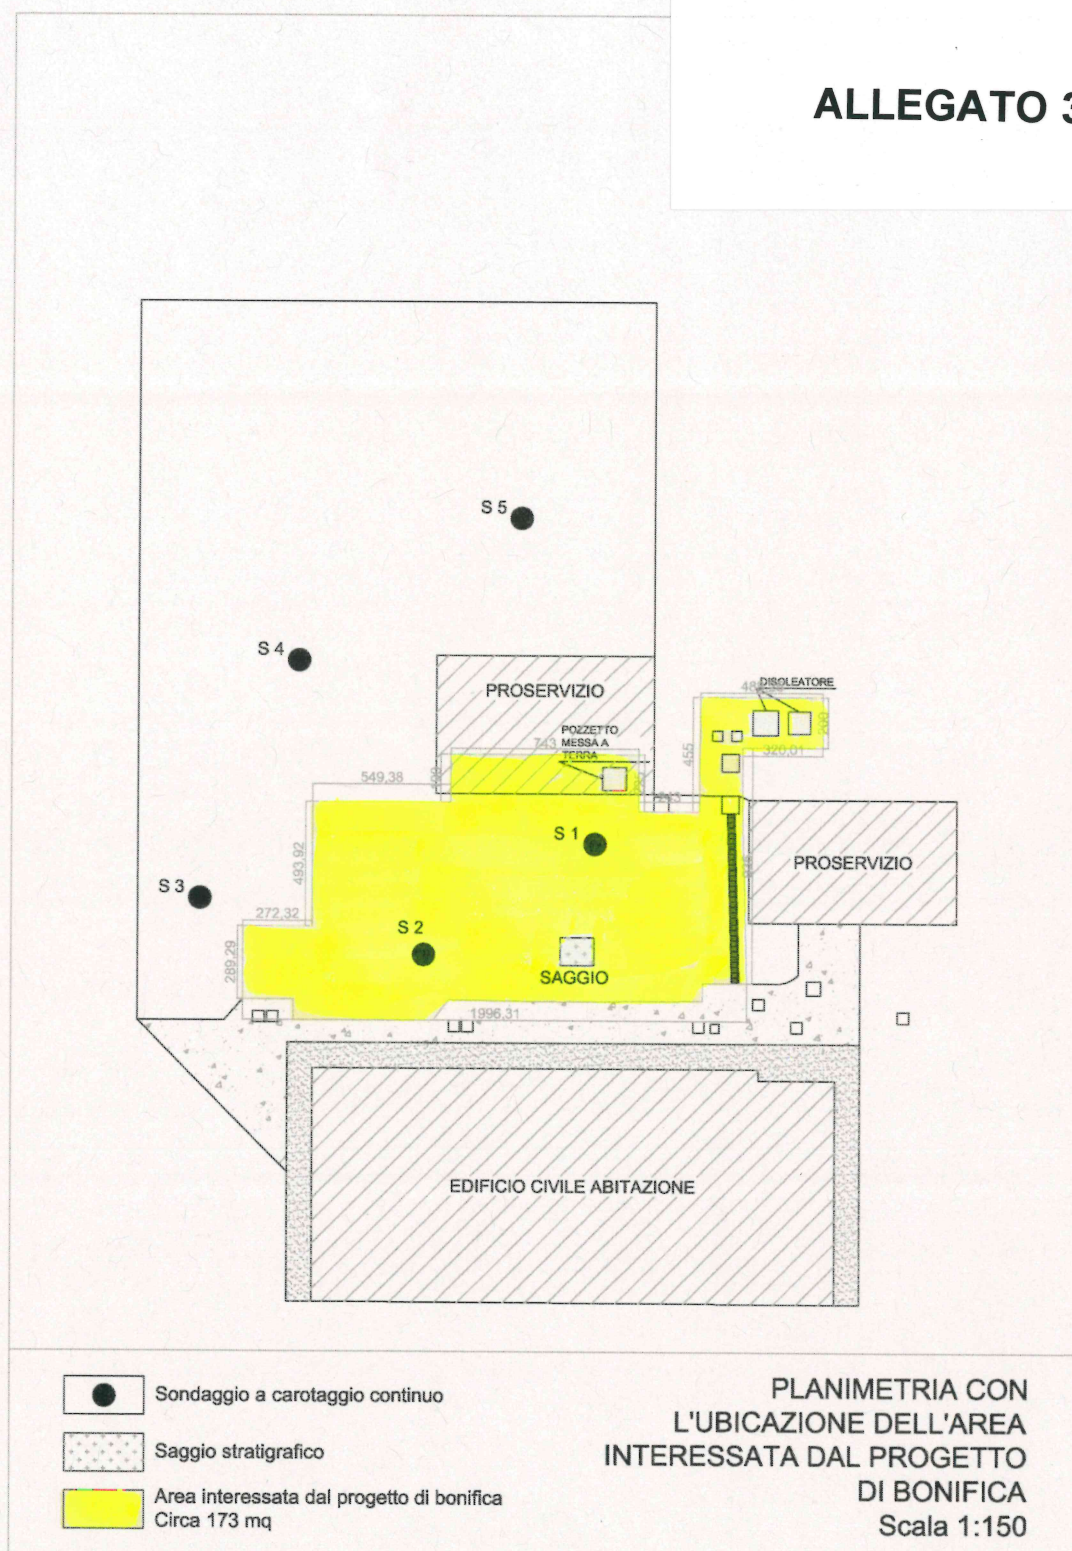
Planimetria dell'area oggetto di bonifica
